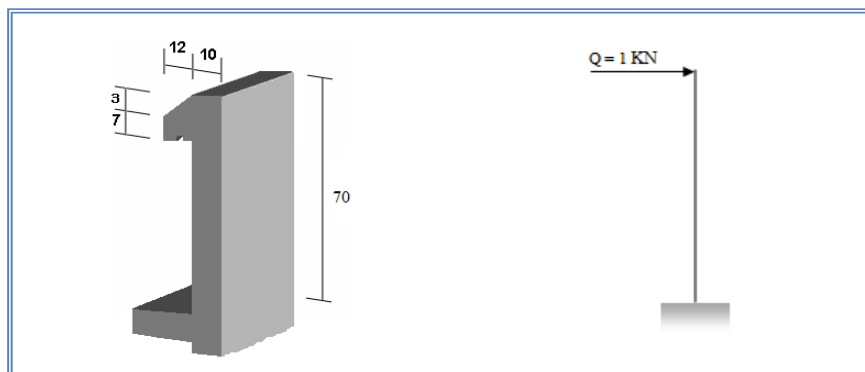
Dimensions et Schéma statique de L'acrotère.
